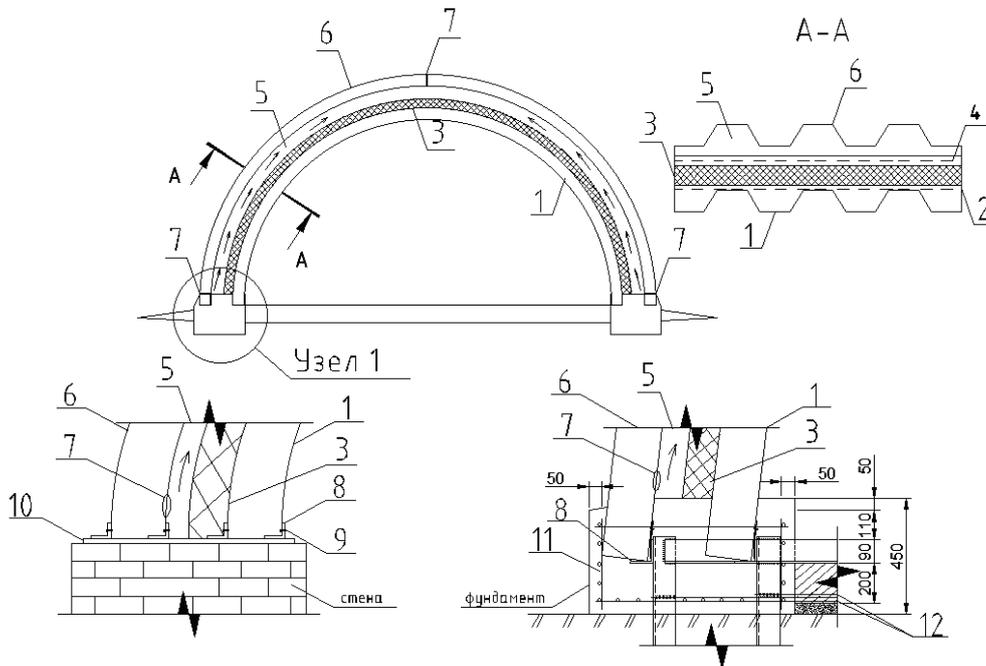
Конструктивное решение сводчатого покрытия, выполненное методом устройства двойной арки из стальных тонкостенных арочных профилей: 1, 6 – нижняя, верхняя арка; 2 – пароизоляция; 3 – утеплитель; 4 – супердиффузионная мембрана; 5 – воздушная вентилируемая прослойка; 7 – вентиляционное отверстие; 8 – уголок; 9 – крепления на саморезах; 10 – опорная пластина; 11 – арматурная сетка; 12 – затяжка.
